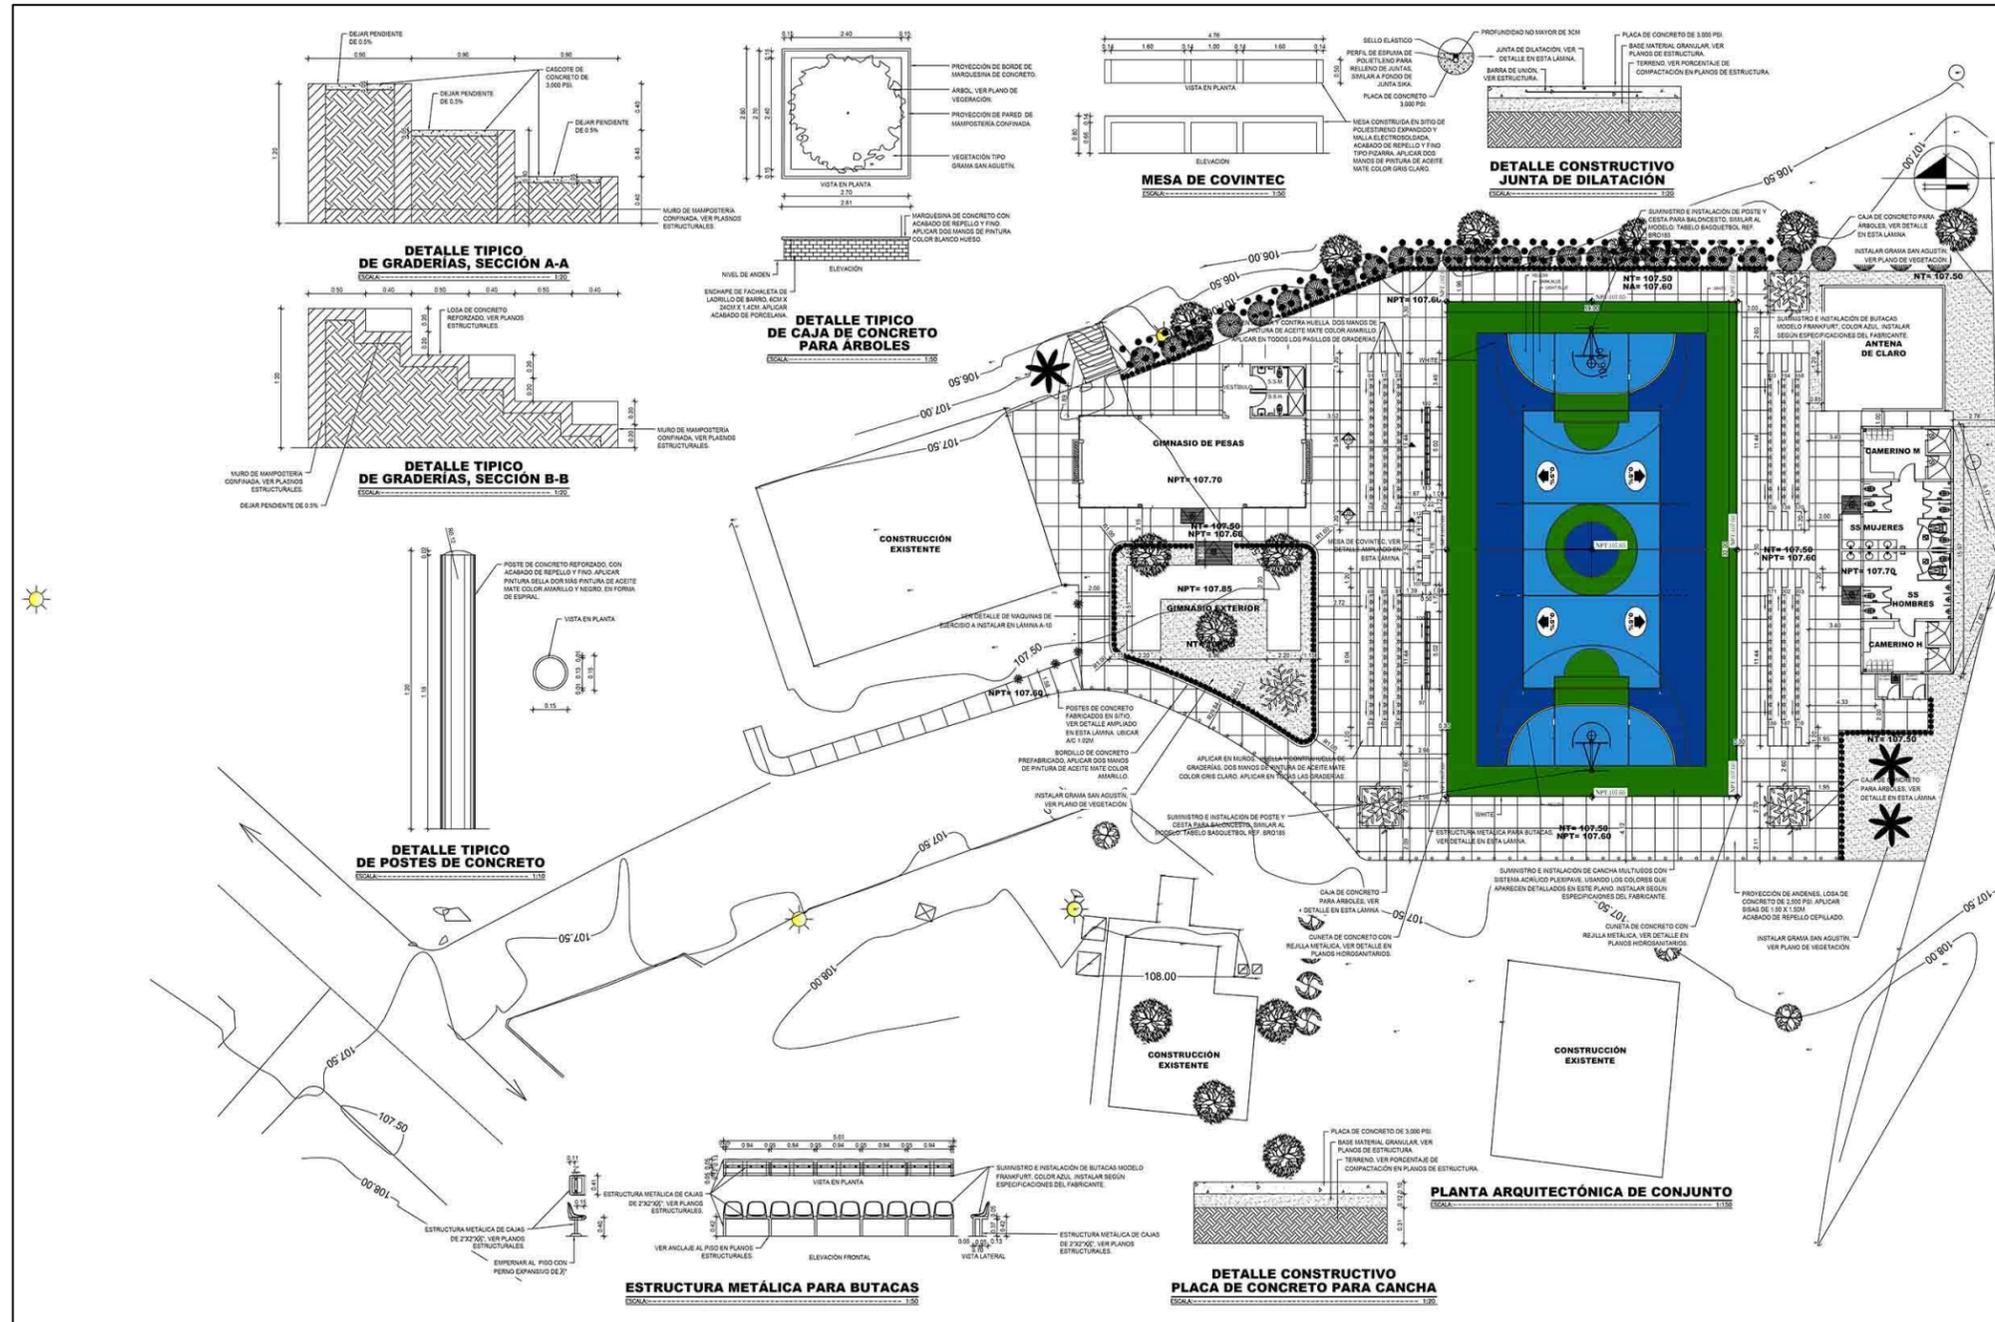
Planta arquitectónica de Conjunto de Cancha Multiusos Faustino Ruiz
